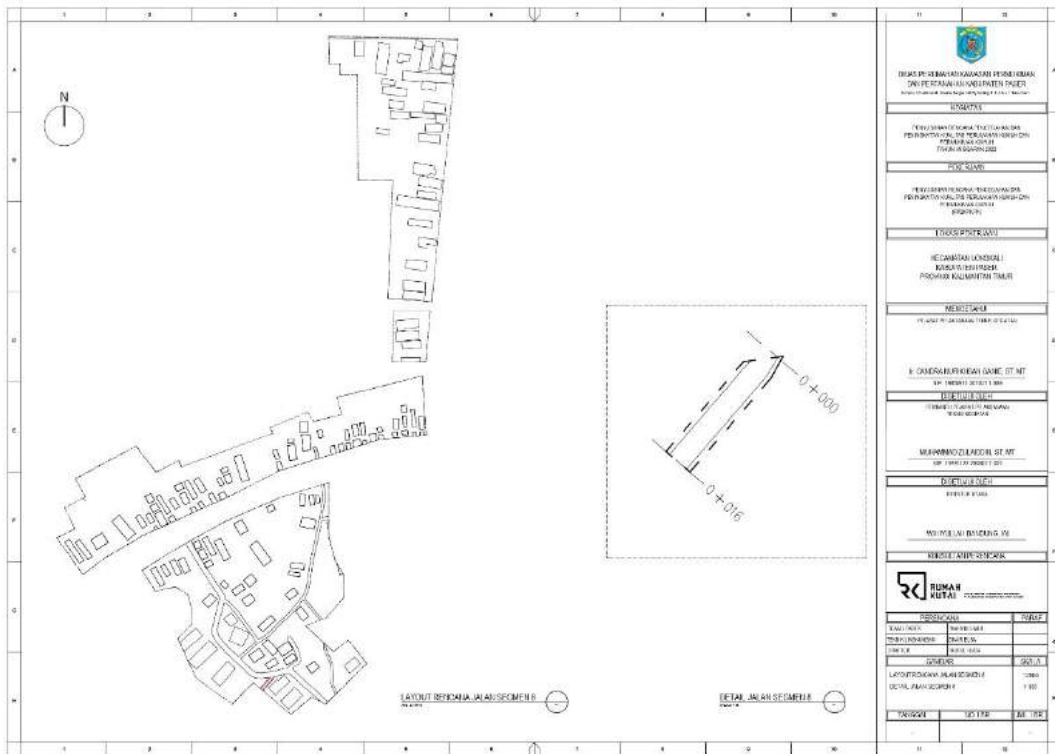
111 Konsep Rencana Jalan Segmen 6 RT.16
